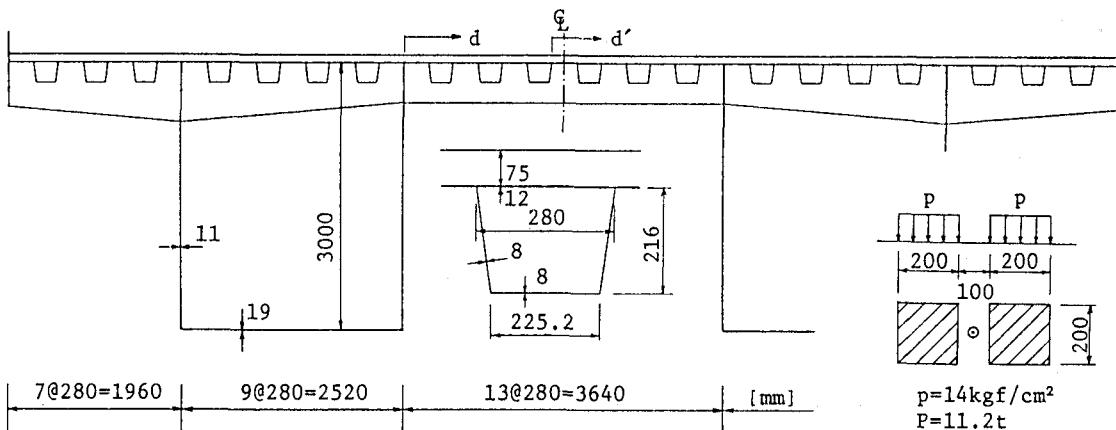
鋼床版箱桁橋断面図と縦リブ詳細図および複輪荷重
